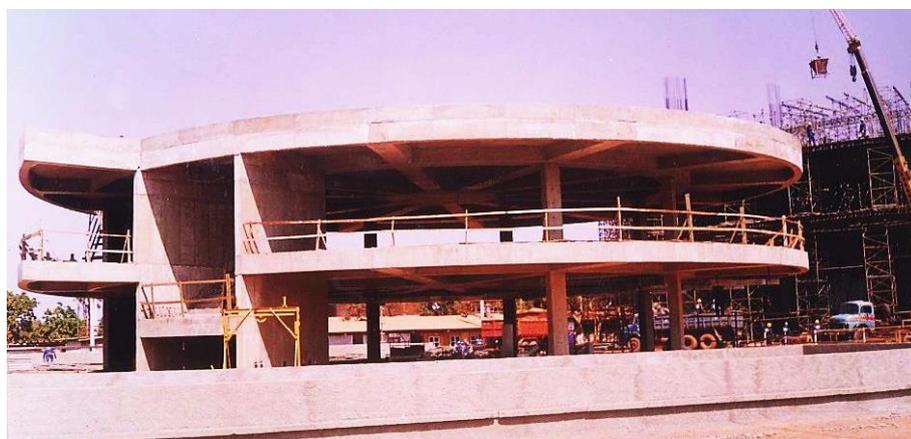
Estrutura do Bloco E em fase de construção. Fonte: Arquivo da PGR.
